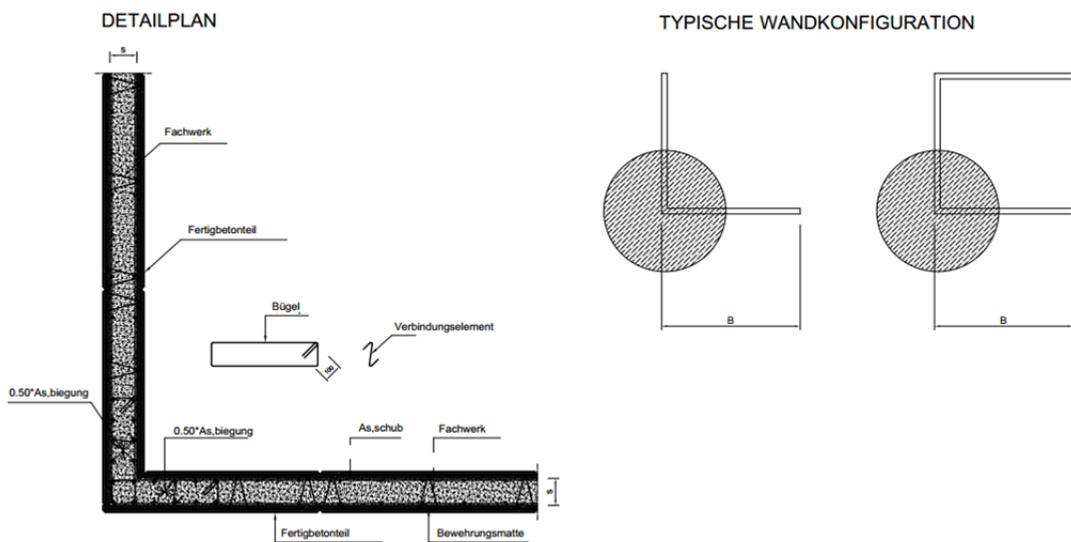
Typisches Eckendetail für Stahlbeton-Wandaussteifung und typische Wandkonfigurationen (Aufsicht).
